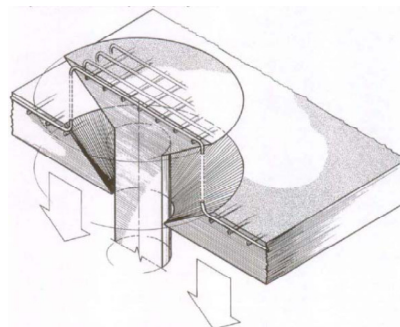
Esquema de rotura ao punçoamento de uma laje de betão armado [16]
